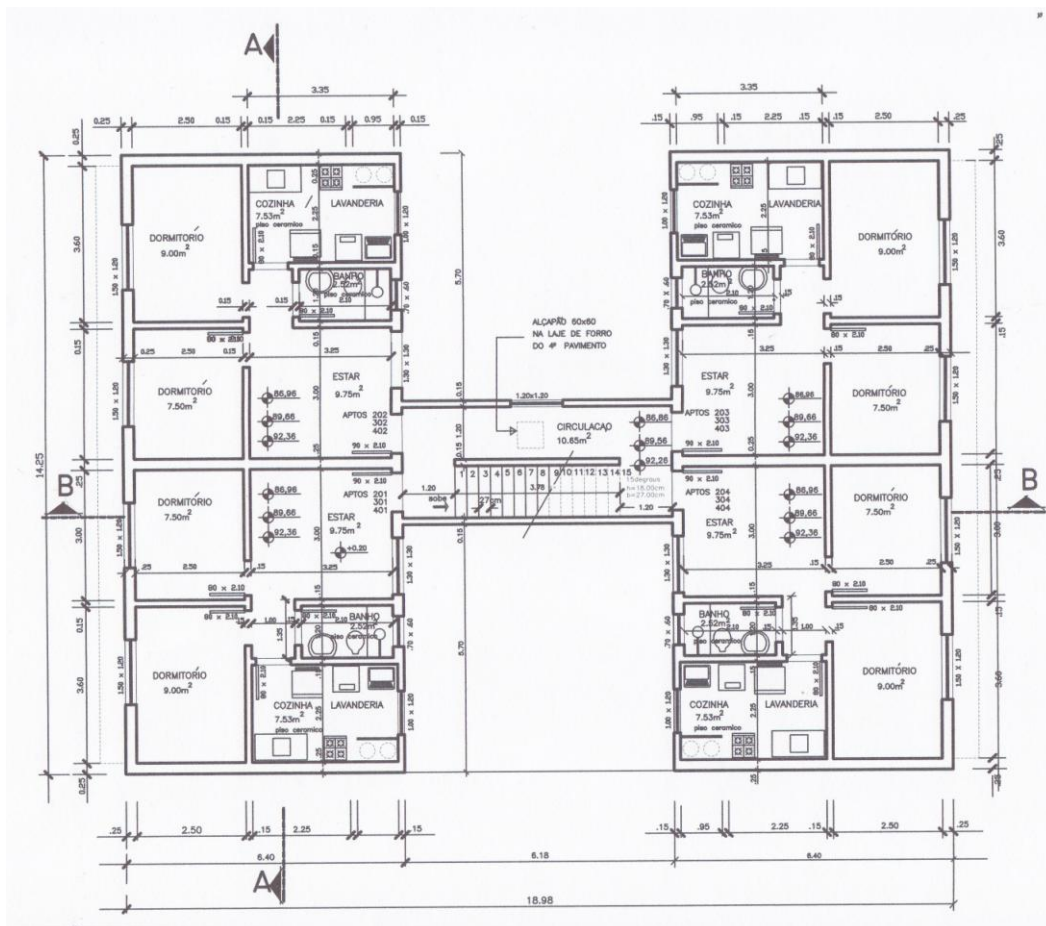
Plano de la planta tipo del conjunto de edificios Amizade.
